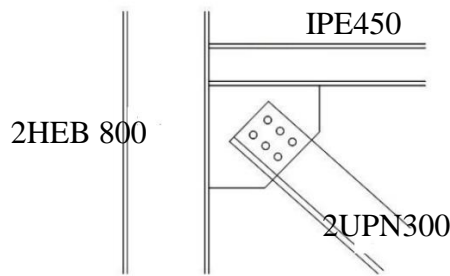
Assemblage gousset – contreventement au nœud du portique.
